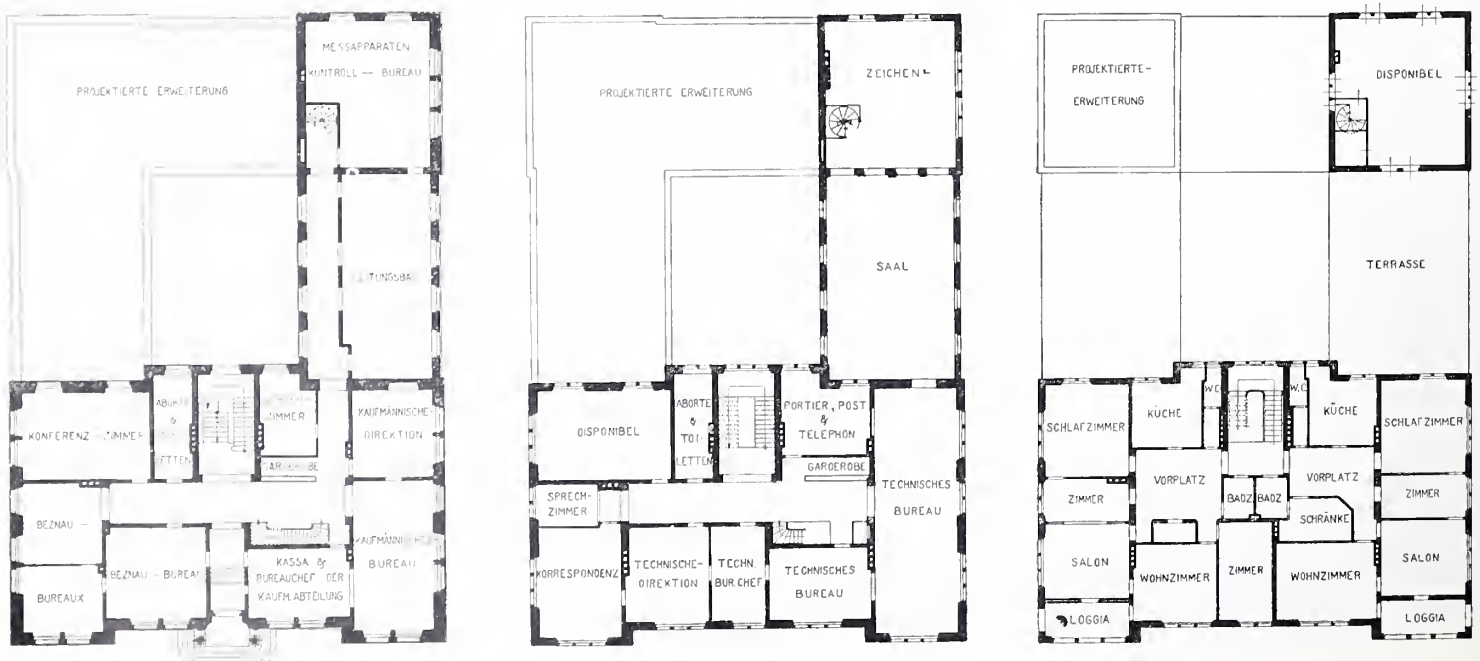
, 2 und 3. Grundrisse vom Erdgeschoss, I. Stock und II. Stock. — Masstab 1 : 500.
